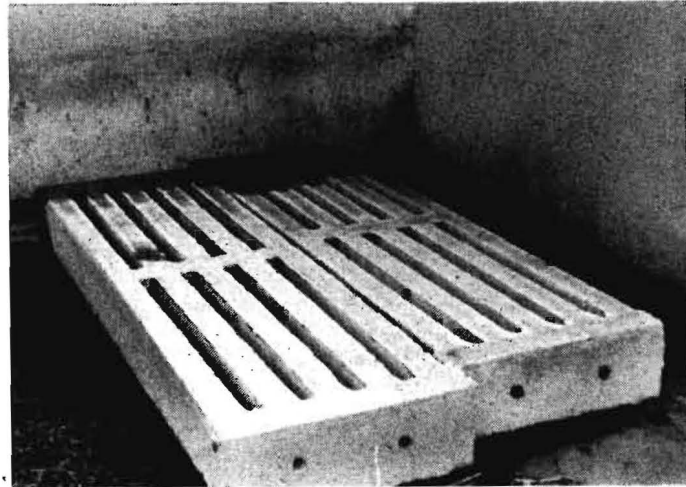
Stahlbetonspaltenbodenelement KLZF für Unterflurkanal
